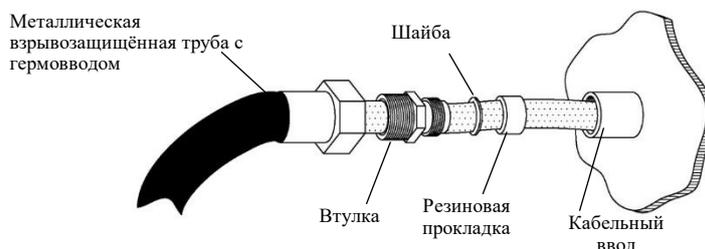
Прокладка кабеля в металлической взрывозащищённой трубе
